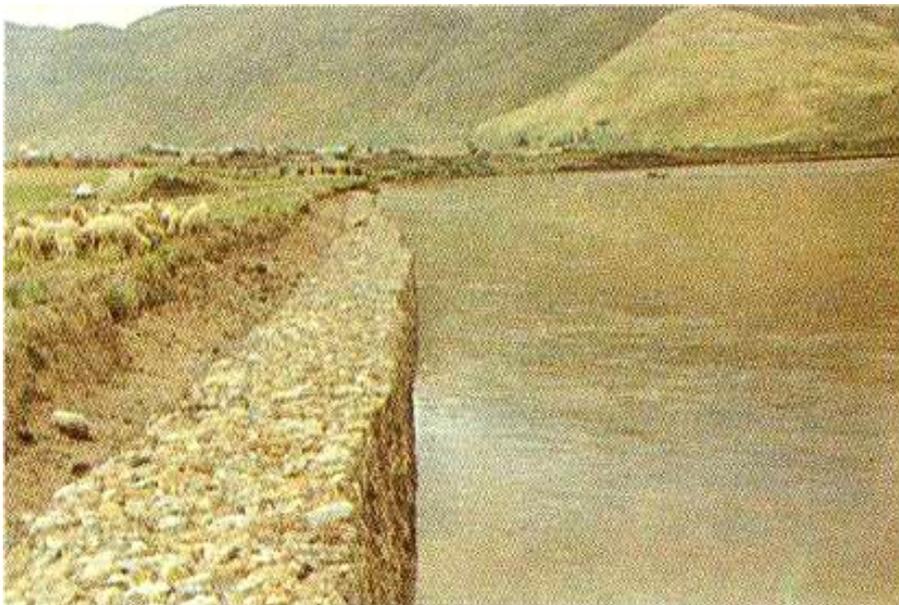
Ejemplo de muro longitudinal para el encauzamiento del río. (Tomado de PROLANSA).
